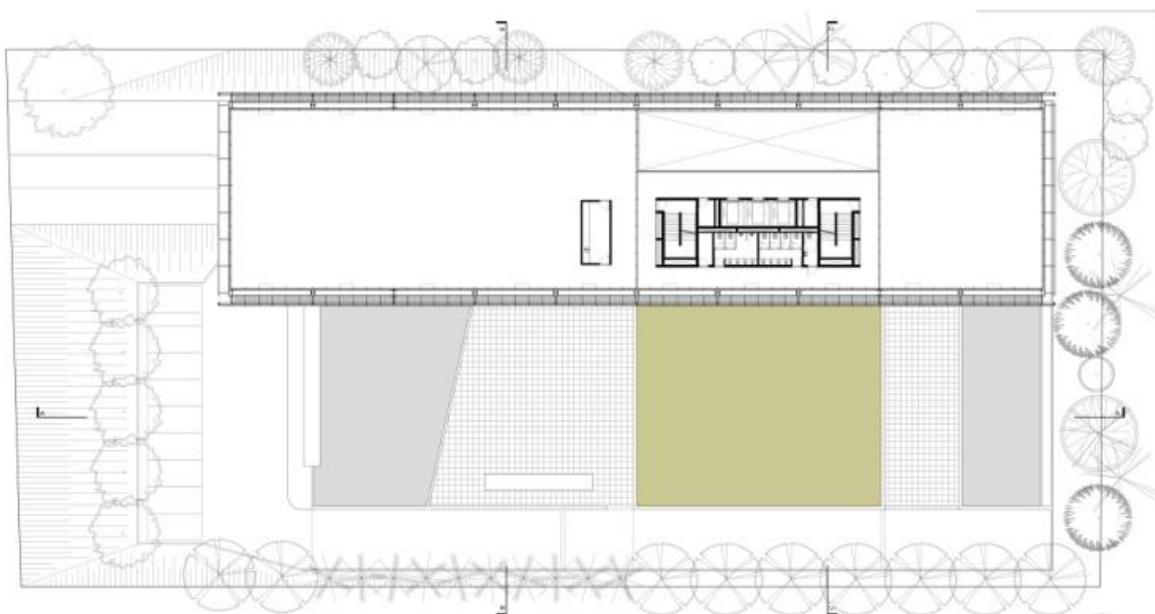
CNM planta do pavimento tipo. Imagem do site concursodeprojetos.org
